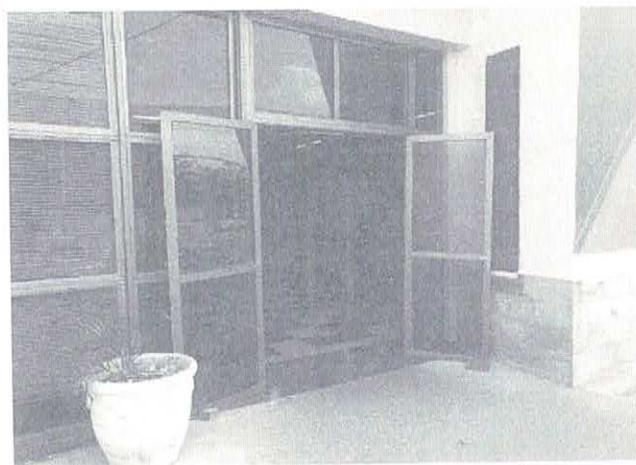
ACESSO TÉRREO AO ELEVADOR PRIVATIVO
